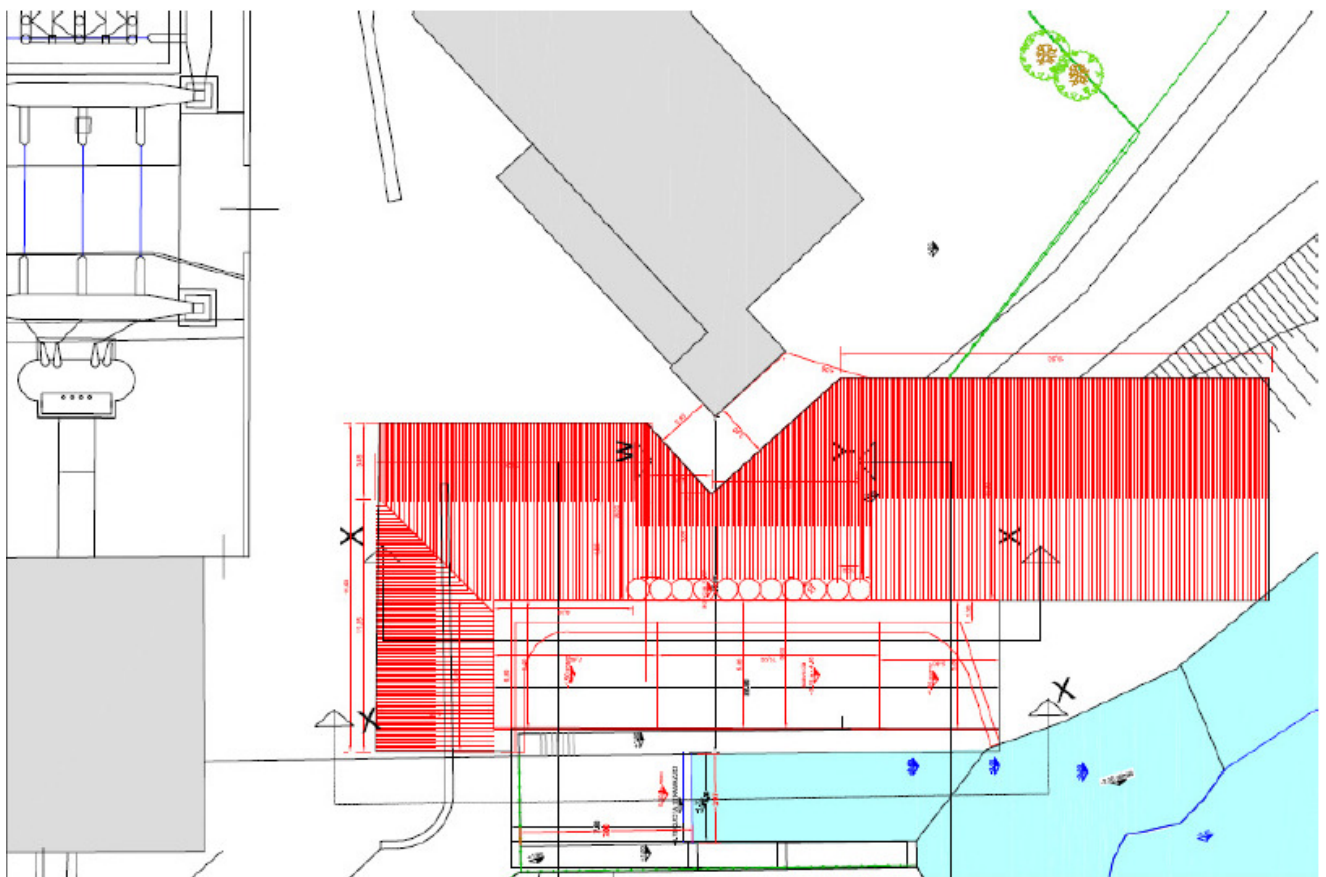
planimetria pianta di sbancamento dell'intervento in progetto.
